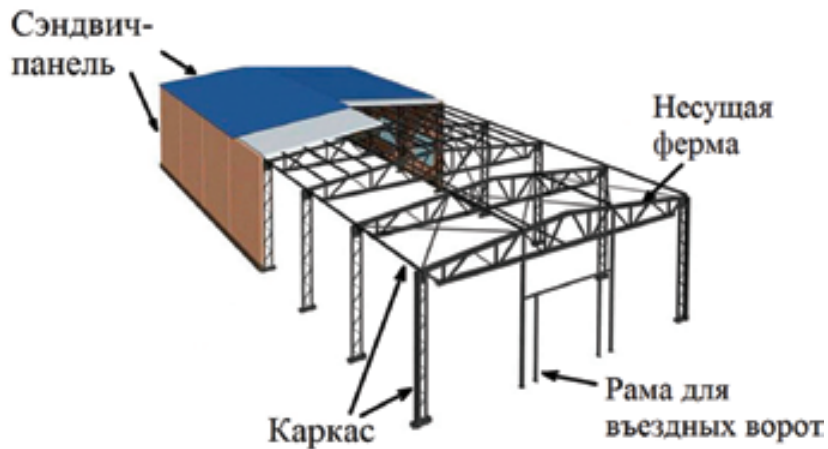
Каркасное хранилище из сэндвич-панелей
